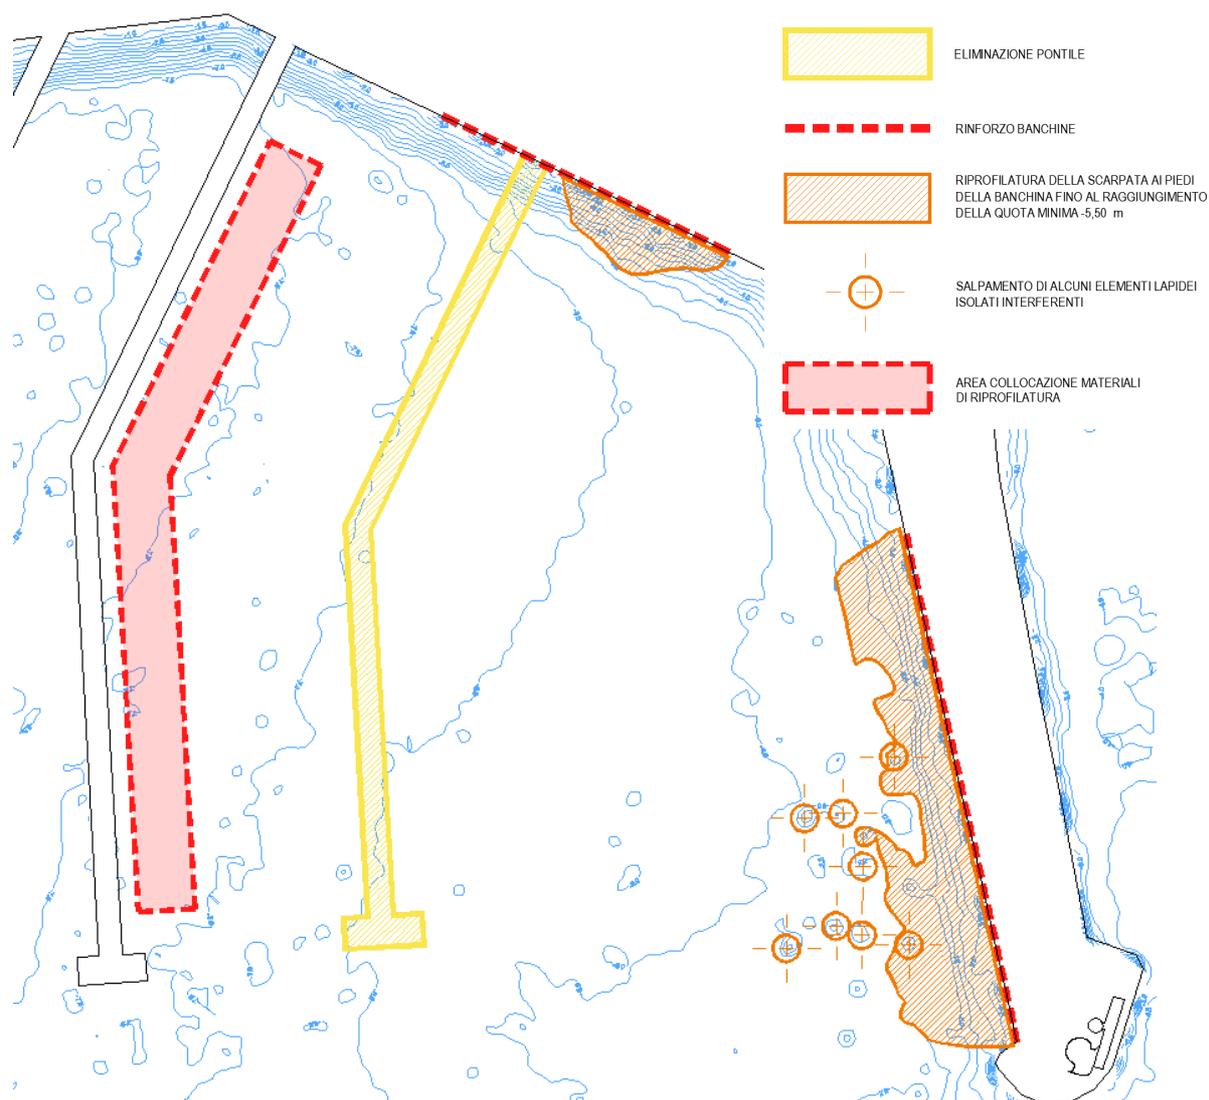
Stralcio elaborato D-05: planimetria con indicazione delle aree di riprofilatura delle scarpate ai piedi delle banchine e dell'area di collocazione dei materiali scavati.
